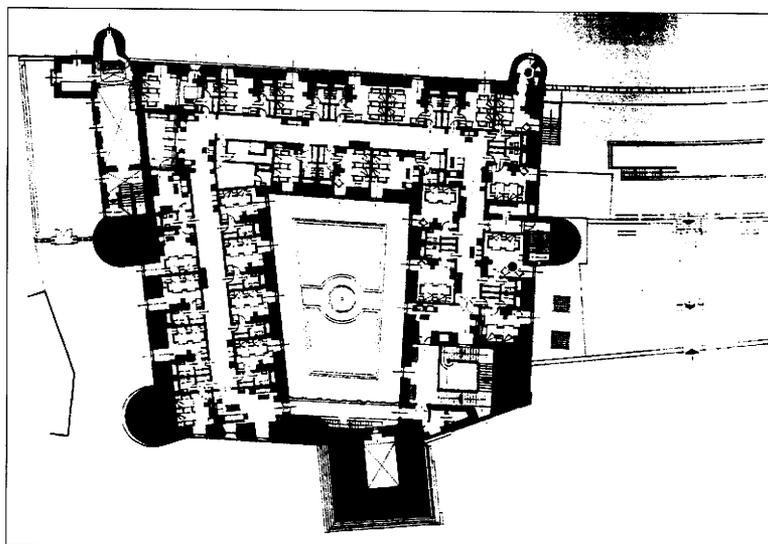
Planta do 1º piso depois da adaptação a pousada
